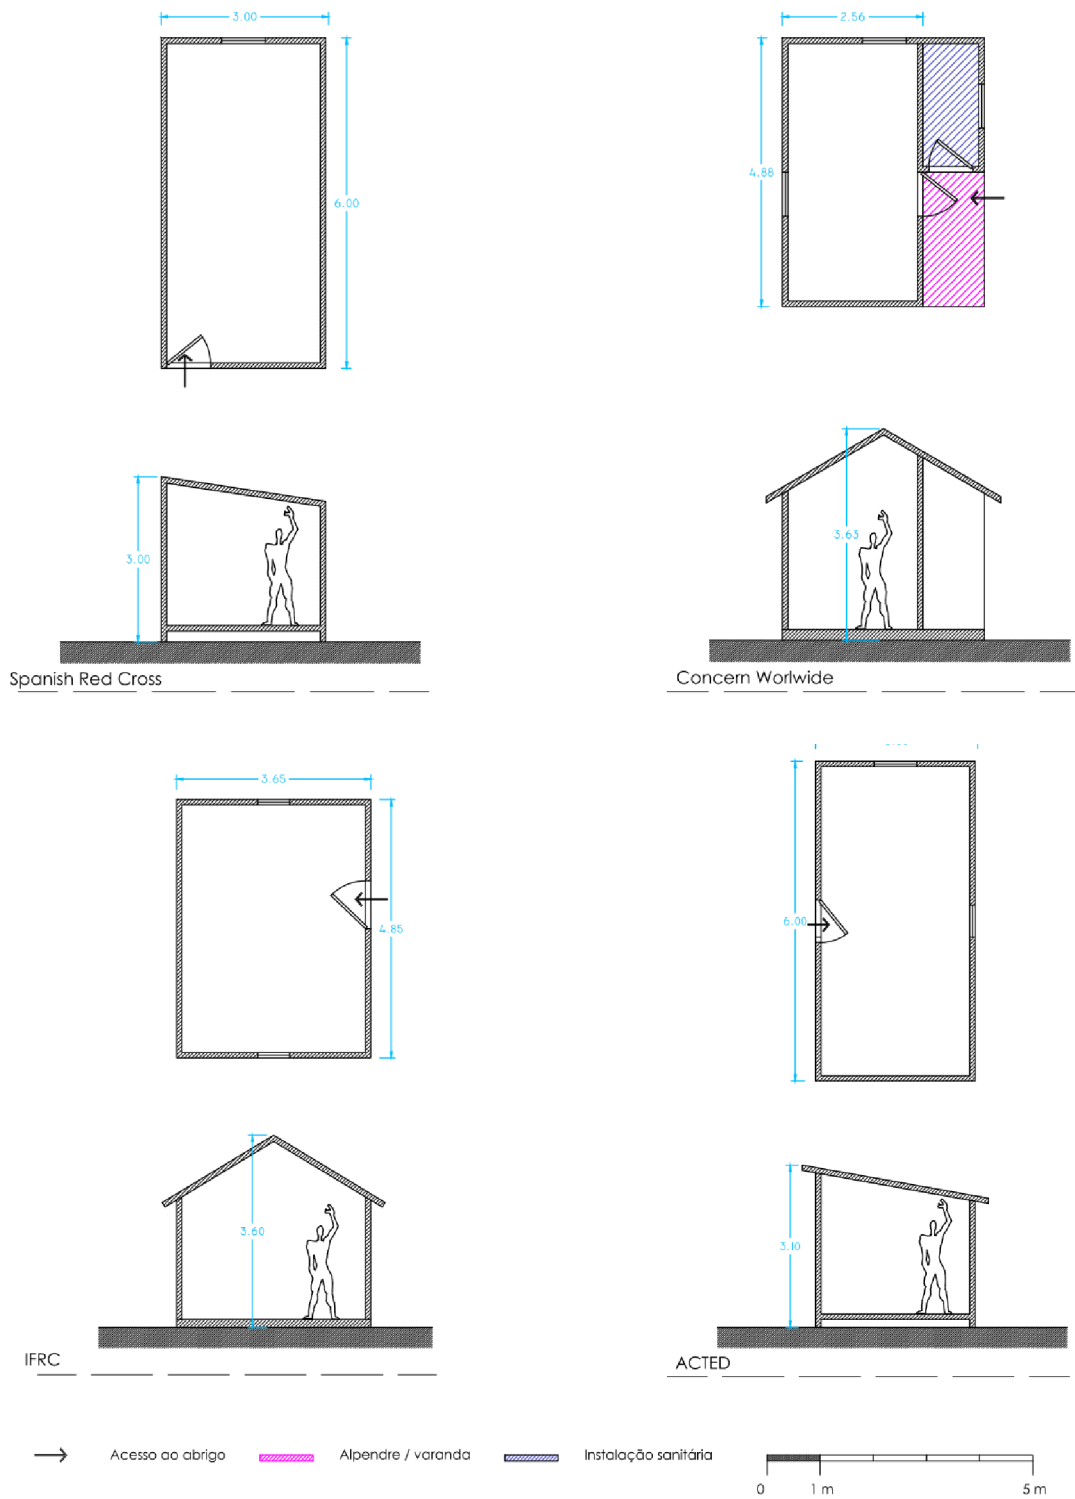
planta e corte esquemáticos dos abrigos transitórios da Spanish Red Cross, da Concern Worldwide, da IFRC e da ACTED.
